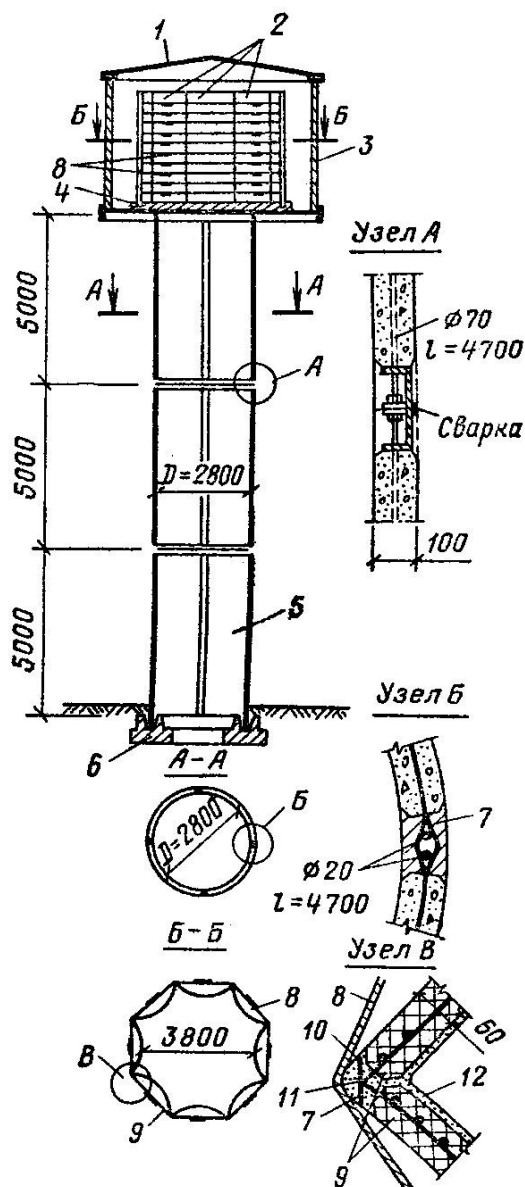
Водонапорная башня из сборного железобетона (проект):
